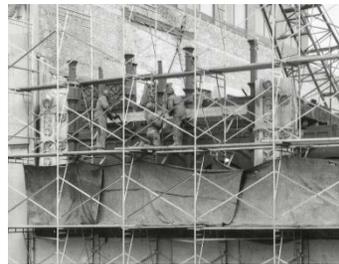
Proceso constructivo (fuente: <https://www.londonremembers.com>)
